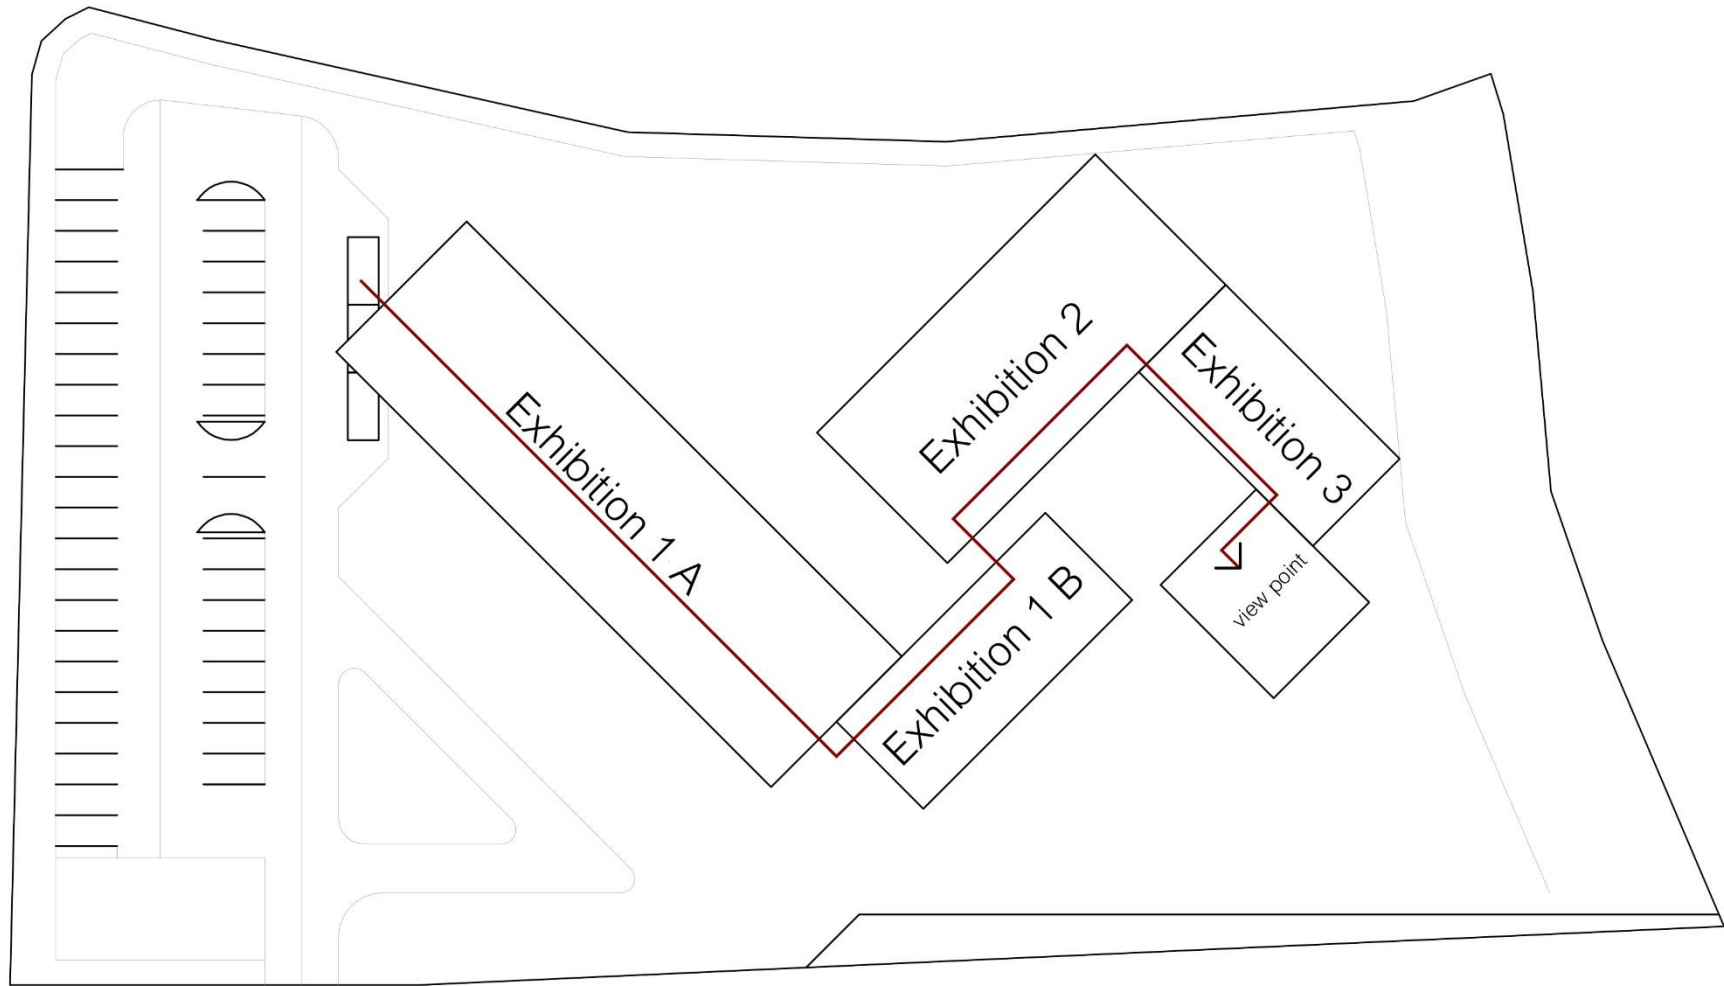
Schematic design 1 ground floor plan - รัชชชัย 2021
